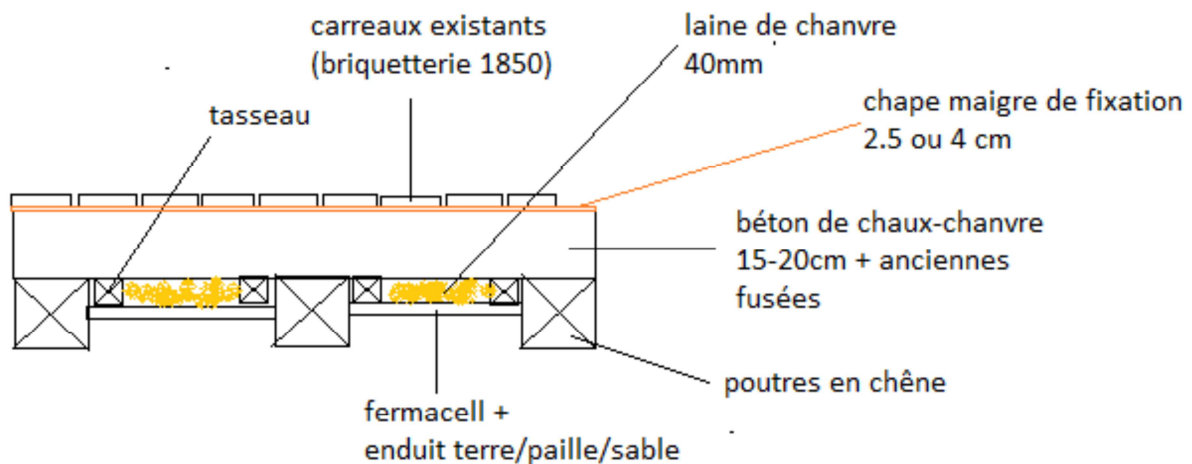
Coupe verticale de l'isolation du plancher haut
